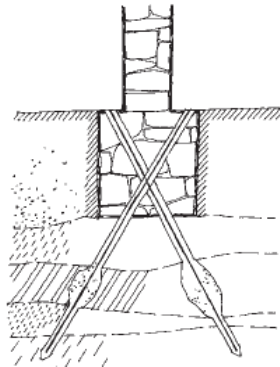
Exemple de confortement de fondations existantes par micropieux, détails de l'arrangement des pieux sous les nouvelles barrettes de fondation.
